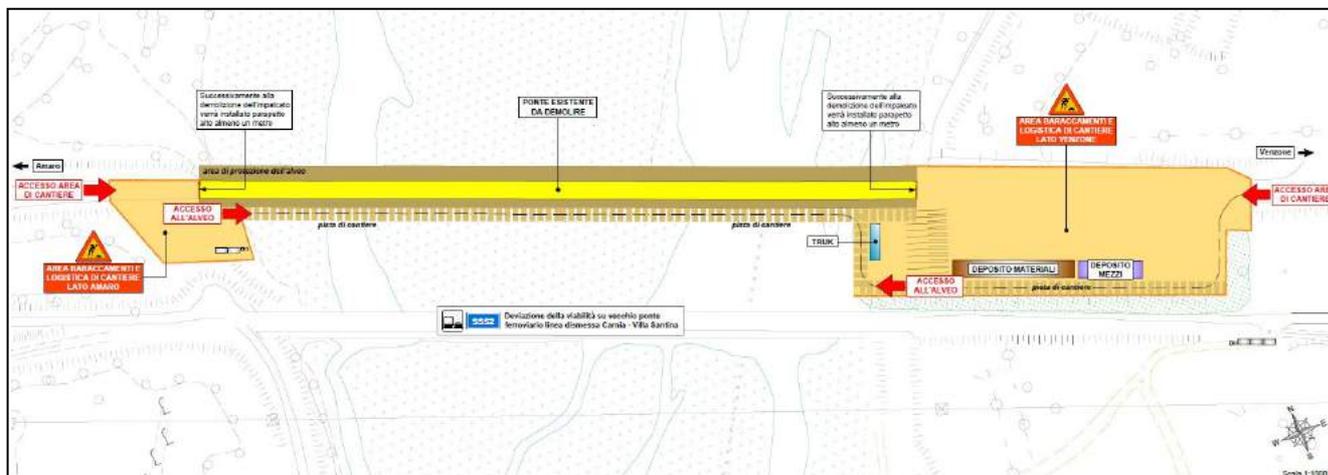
Cantiere fisso: fasi demolizione ponte e lavori in alveo.
